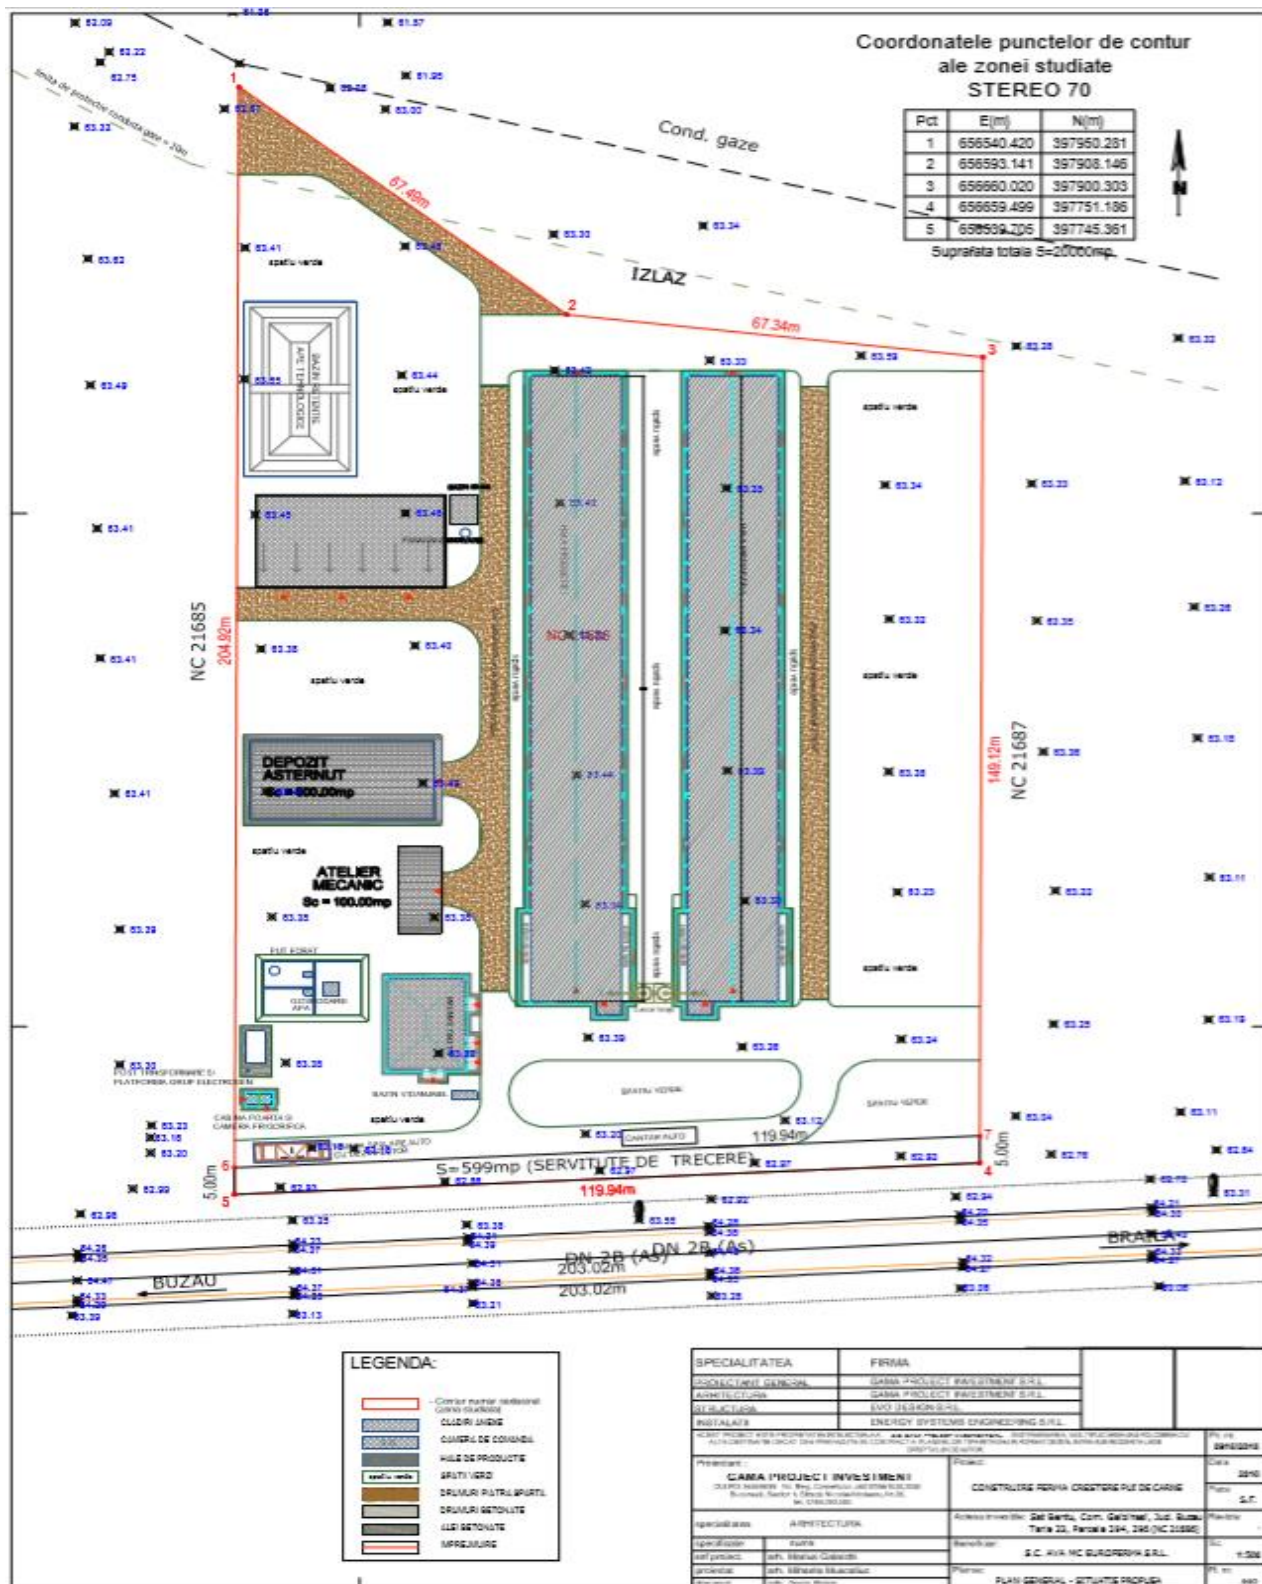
Plan de situație Ferma ROOTARY TRUCKS SRL
